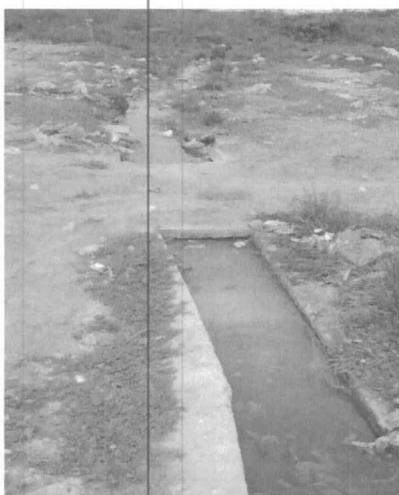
y 4. Se observa el rebosamiento del manhole ubicado en el barrio Villa Nerys
